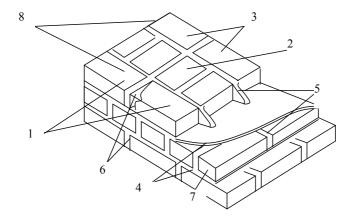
Элементы каменной кладки: 1 — наружная верста; 2 — забутка; 3 — внутренняя верста; 4 — горизонтальный шов; 5 — вертикальный продольный шов; 6 — вертикальный поперечный шов; 7 — тычко́вый ряд; 8 — ложко́вый ряд
